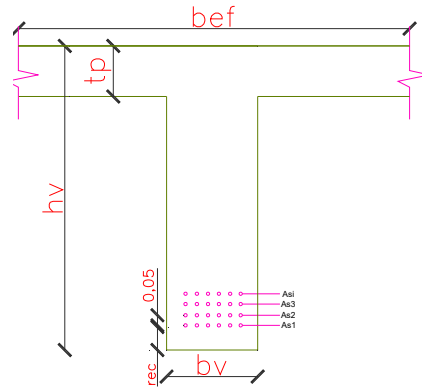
SECCION TIPICA DE VIGA REFORZADA. FUENTE: PROPIA
